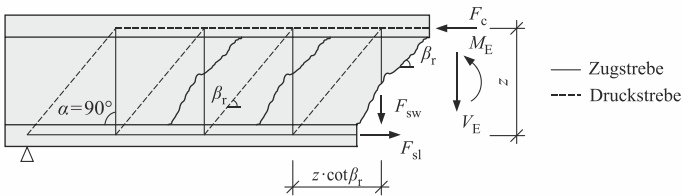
Ausbildung eines statisch bestimmten Fachwerks im gerissenen Stahlbetonbauteil
